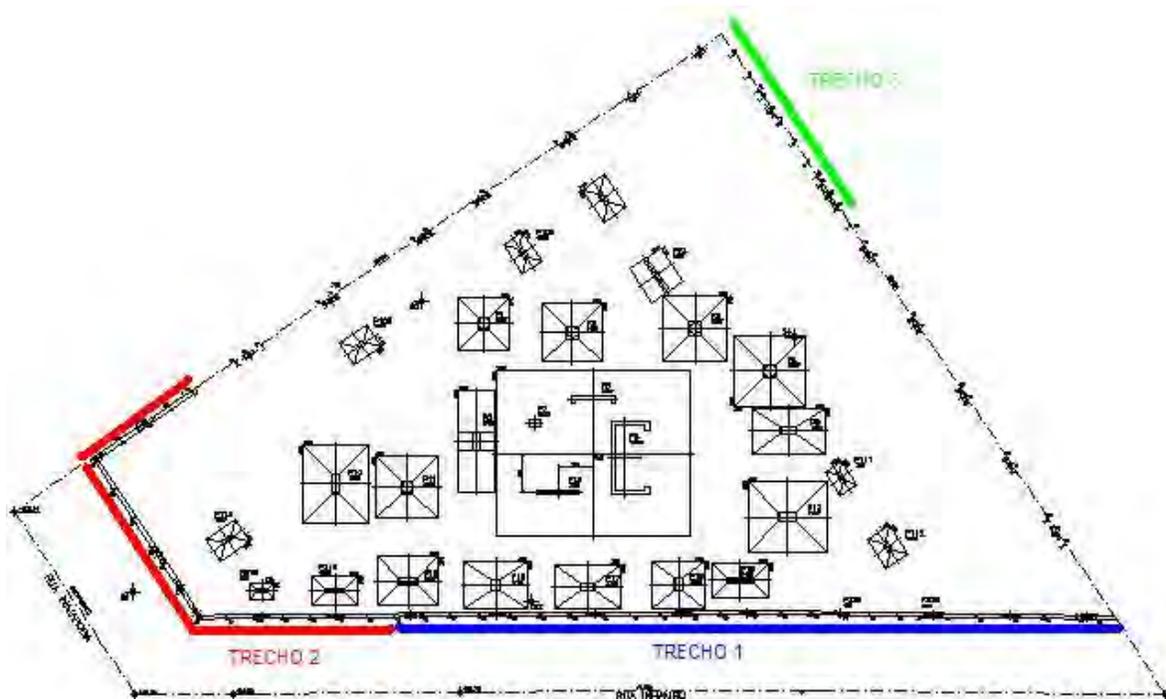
Planta de fundações onde estão em destaque as cortinas executadas.
